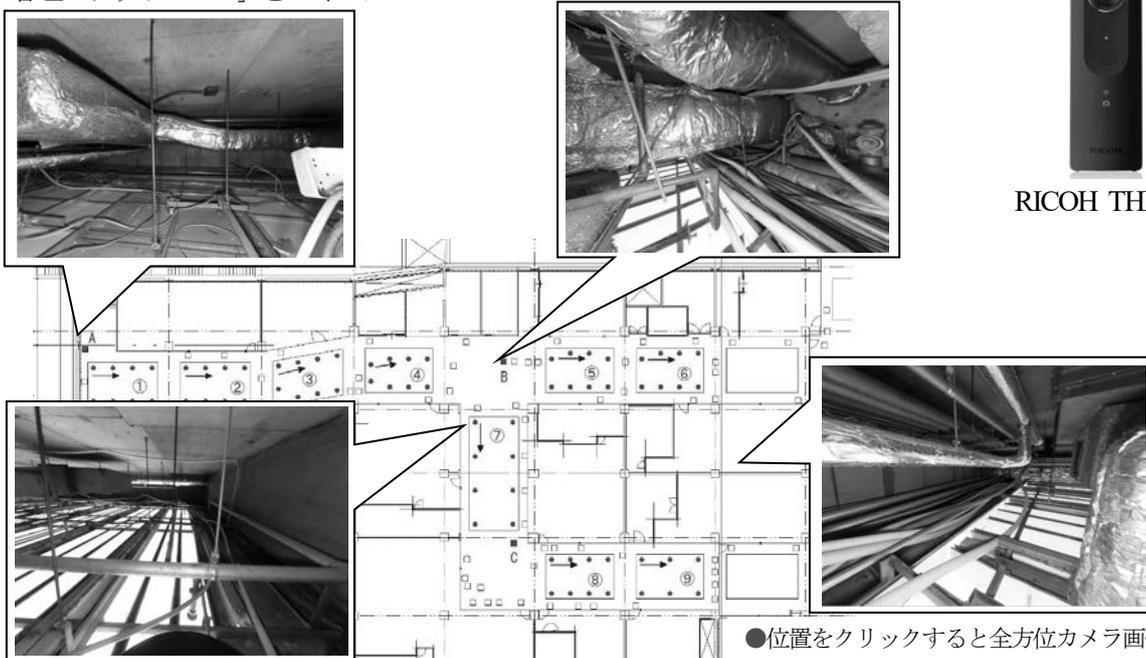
地下街の通路平面図と点検口及び全方位カメラで撮影箇所的位置
